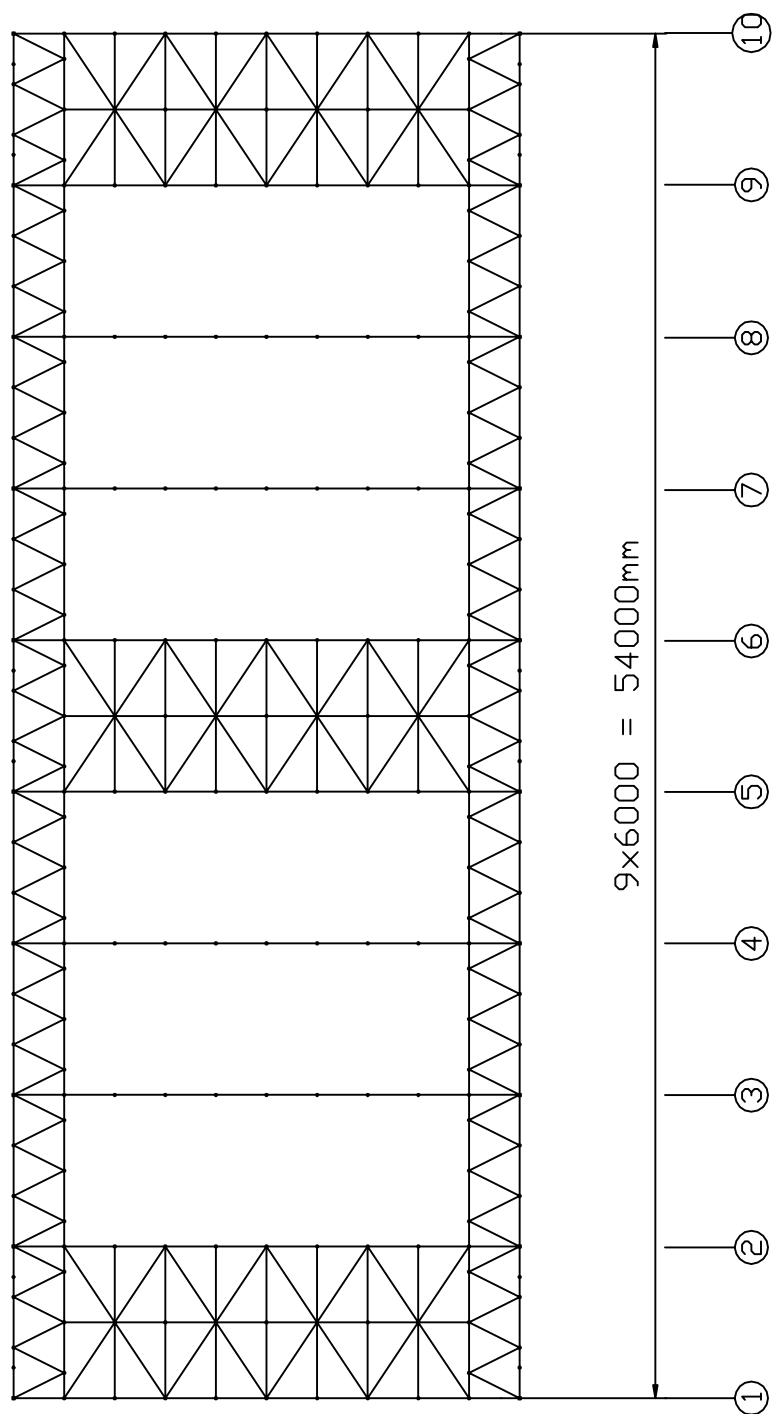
Plano do banzo inferior – Contraventamento horizontal.
